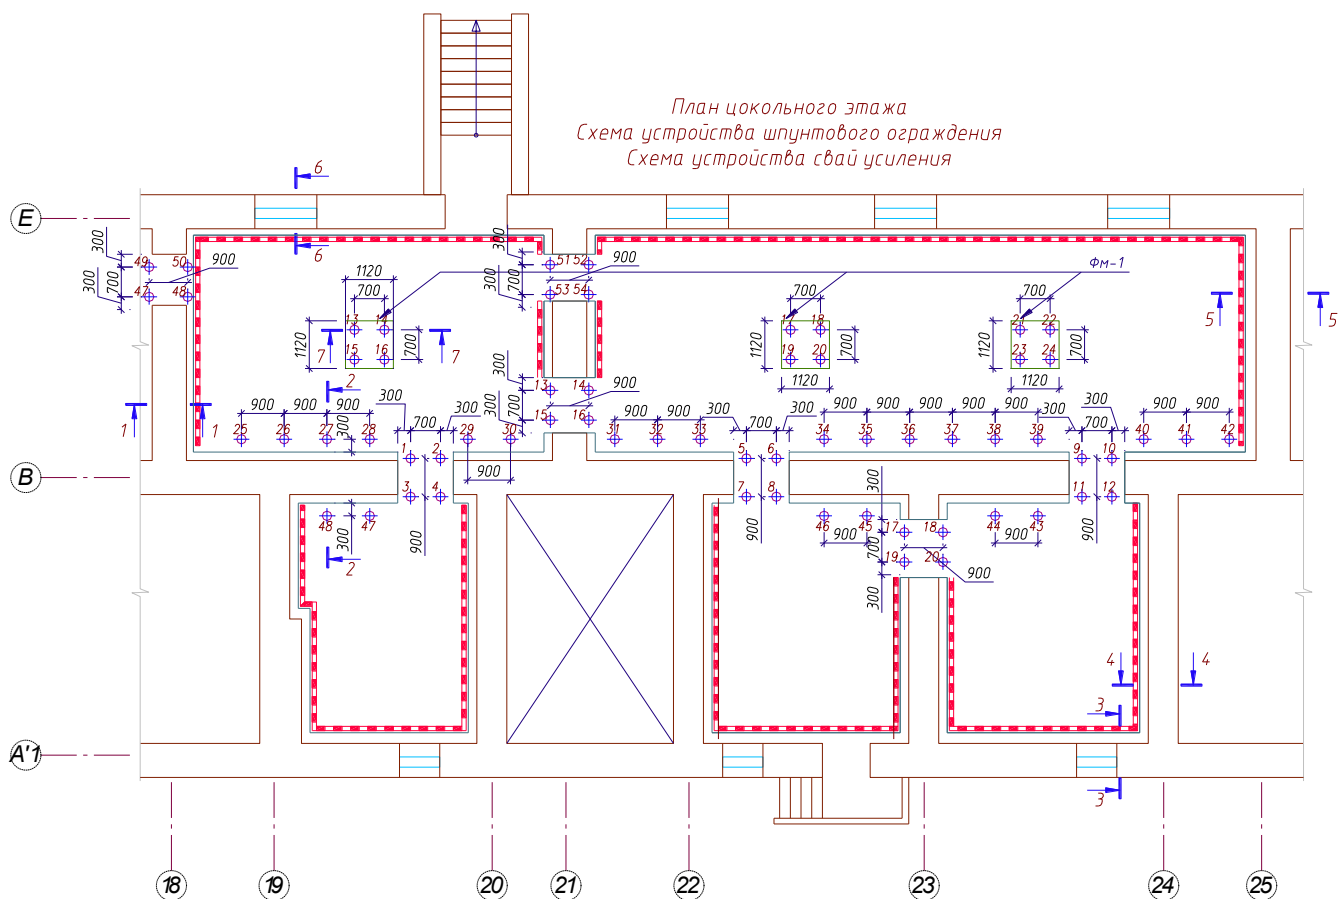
Пример фрагмента плана подвала реконструируемого здания с размещением микросвай усиления основания в виде шпунтовой стенки вдоль оси В с расчётным шагом 900 мм.
